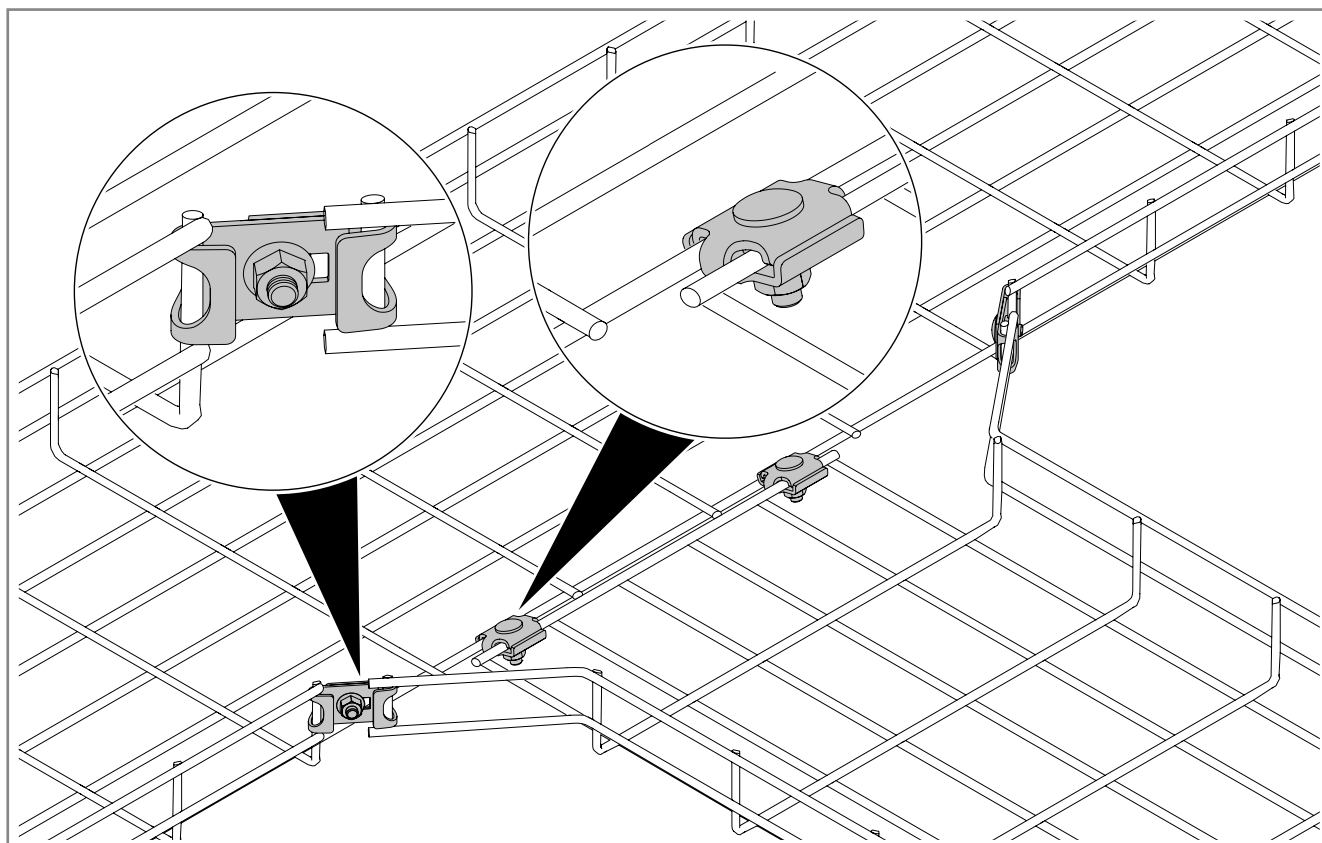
Монтаж углового соединителя и стыкового соединителя
